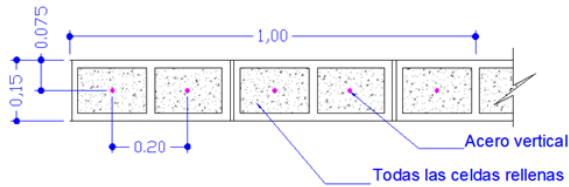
Sección típica de muro de mampostería (medidas en metros)
